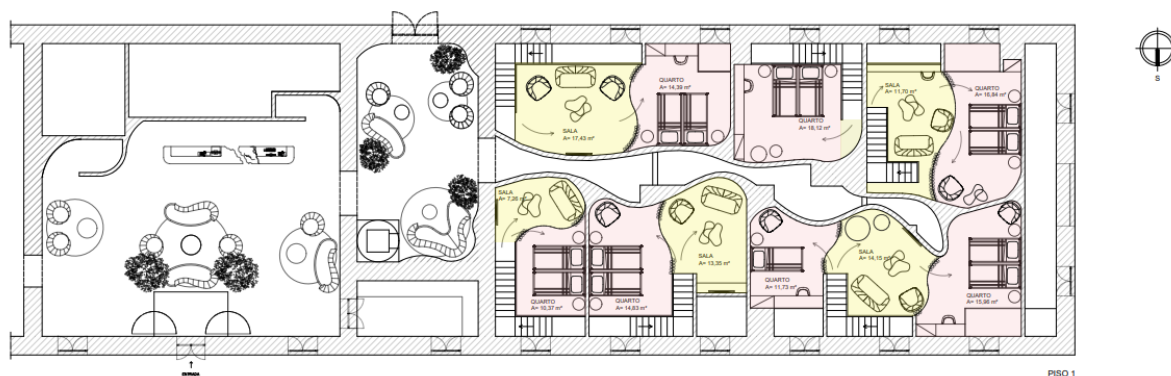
I - Planta de Zonamentos e Circulação, Piso 1
